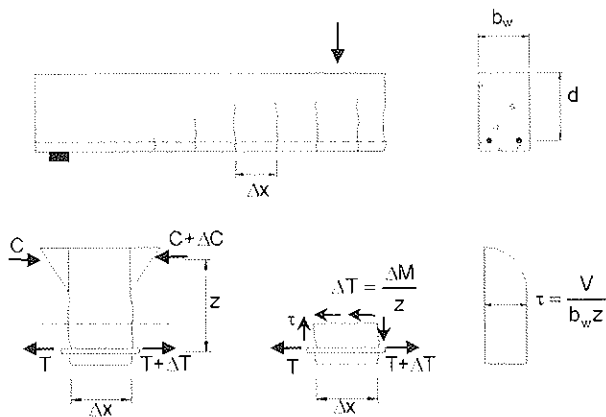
Distribución de las tensiones tangenciales en una viga de hormigón armado con fisuras de flexión (adaptado de Collins y Mitchell, 1991).
